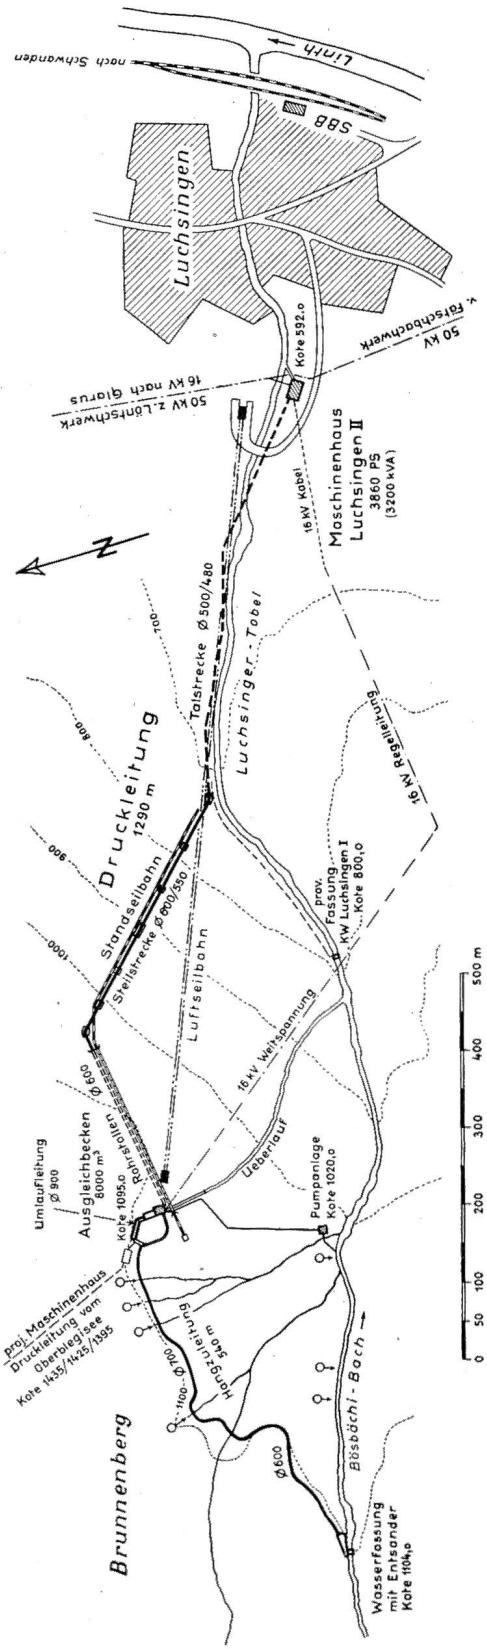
Kraftwerk Luchsingen II. Lageplan, Maßstab 1:10 000.
